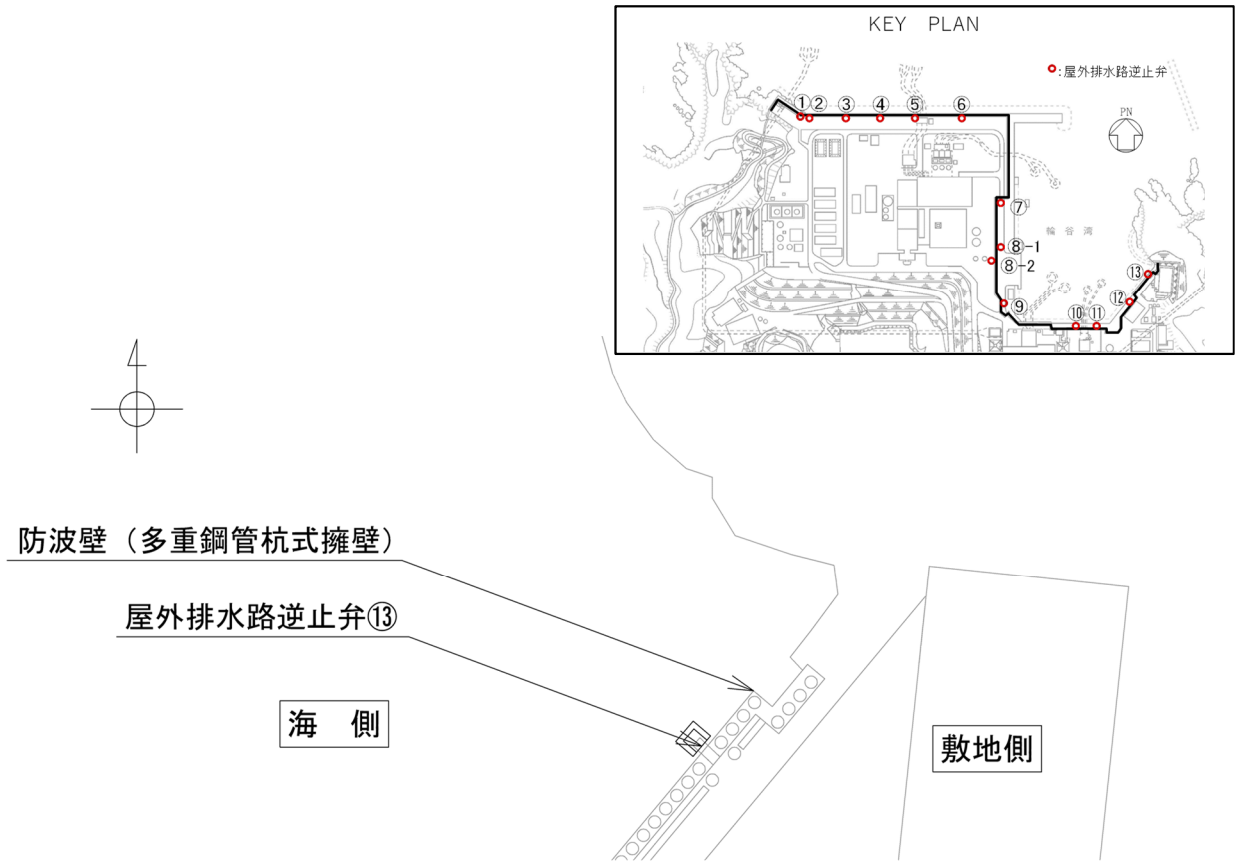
(1) 屋外排水路逆止弁⑬平面図
